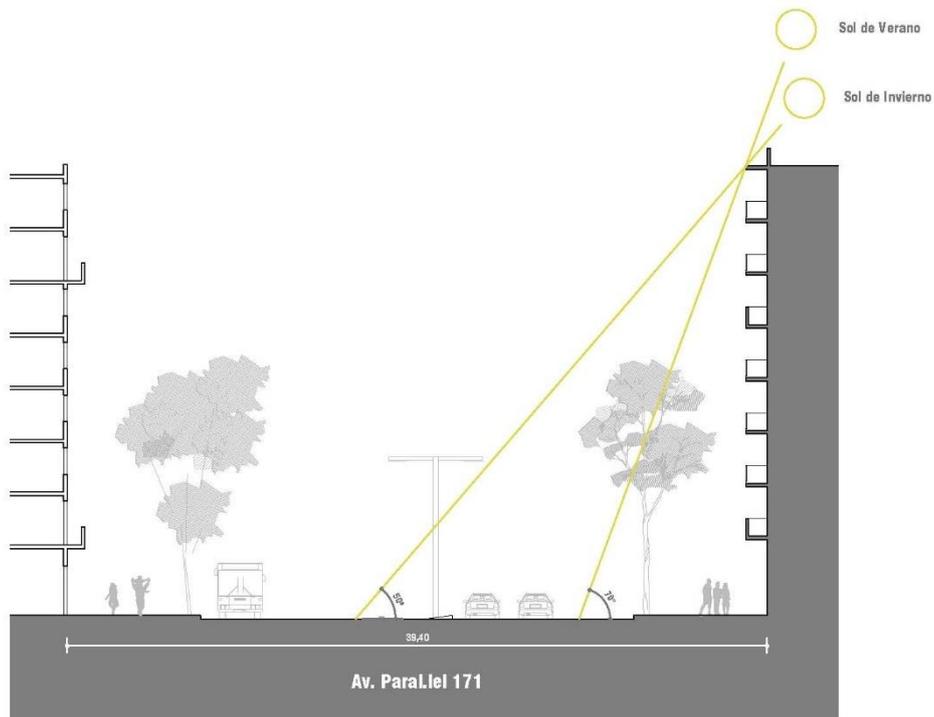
Sección transversal Av. Paral·lel garantiza un buen asoleamiento de las fachadas.
